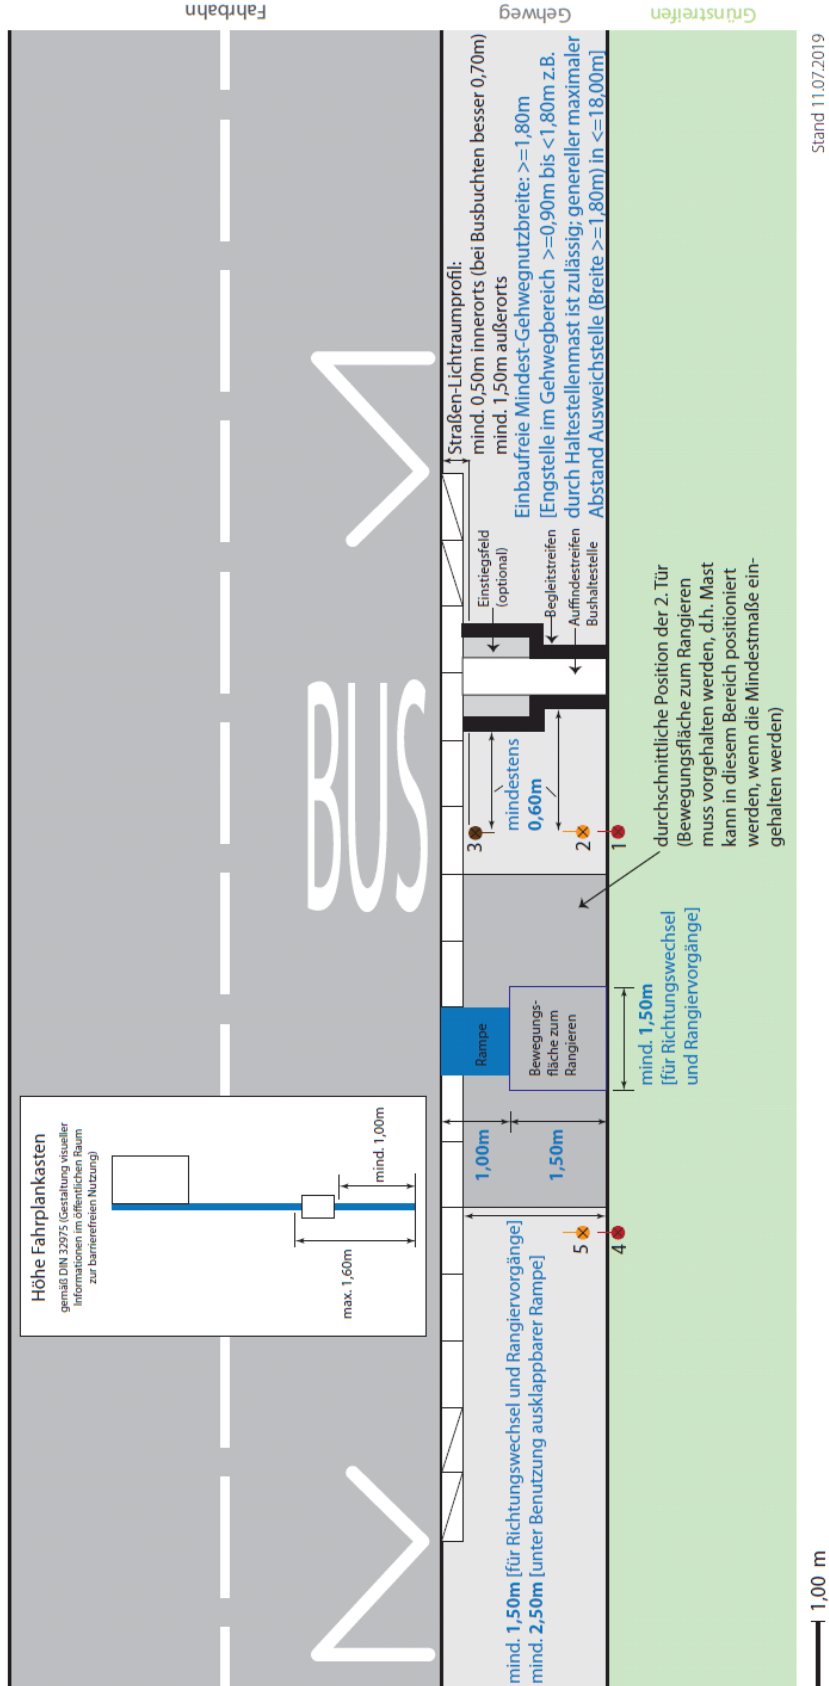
Haltestellenplan mit Vorzugsvarianten für den Maststandort
